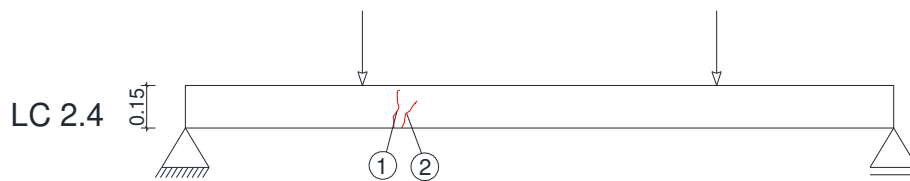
Ilustração da fissuração e posição relativa das fissuras da laje LC 2.4 ($h_t = 15$ cm)
